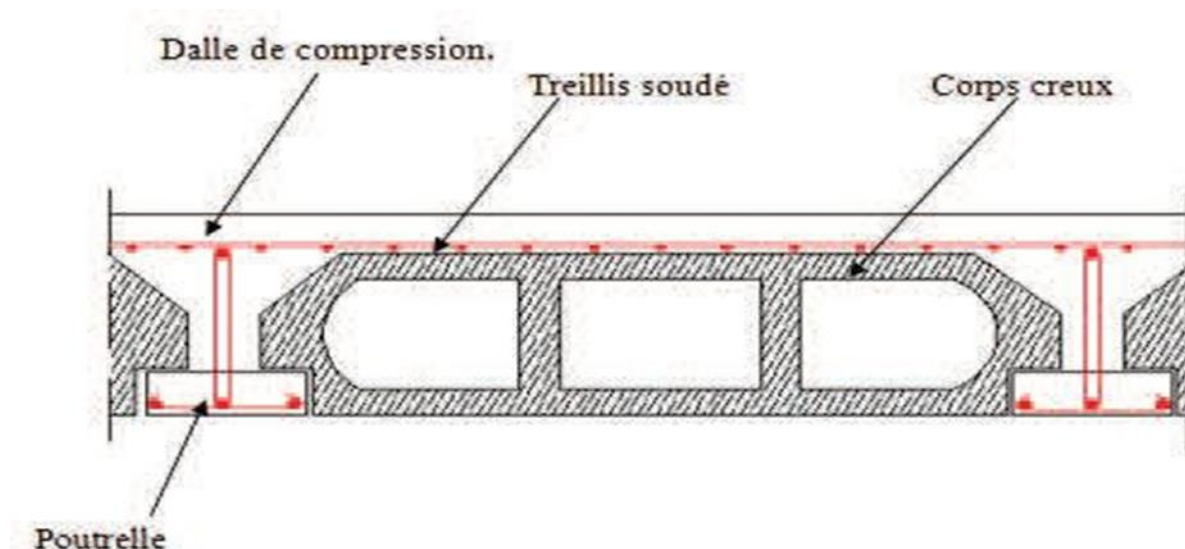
Coupe transversale d'un plancher en corps creux.
